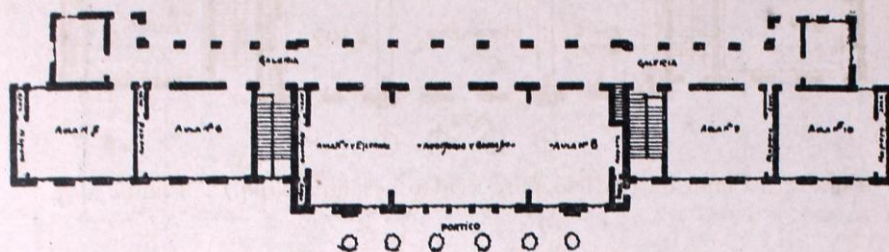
Plano de edificio para centro escolar. Tipo B. Planta baja.
